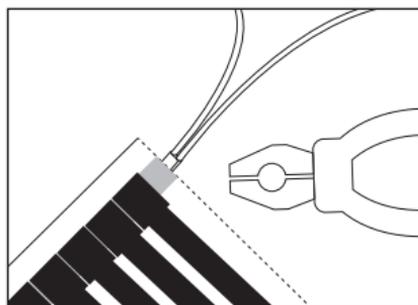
Подключение к нагревательной пленке установочных проводов.
